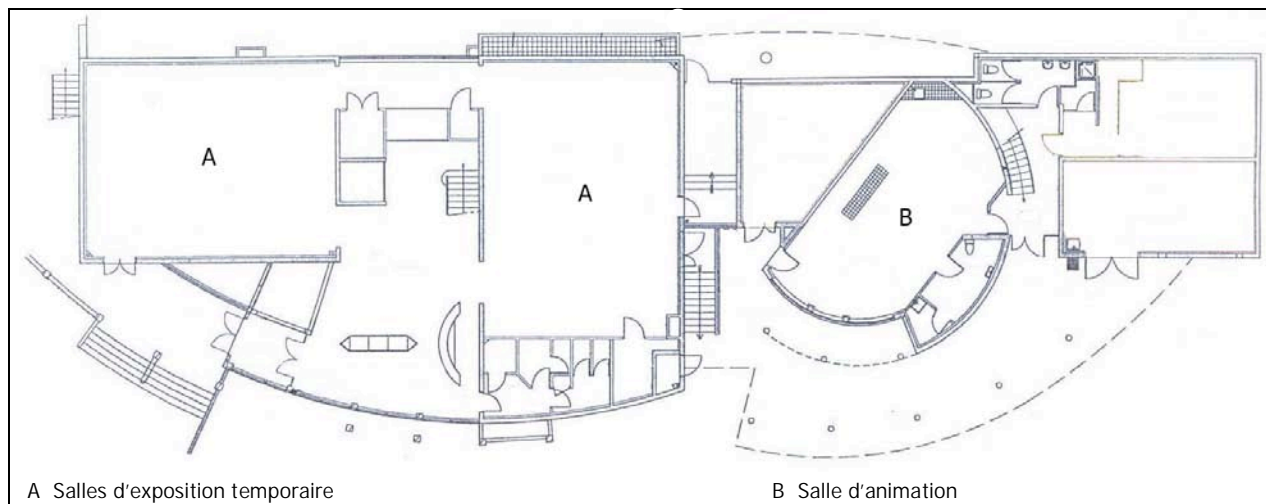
plan du rez-de-chaussée du Pavillon du Raines.
